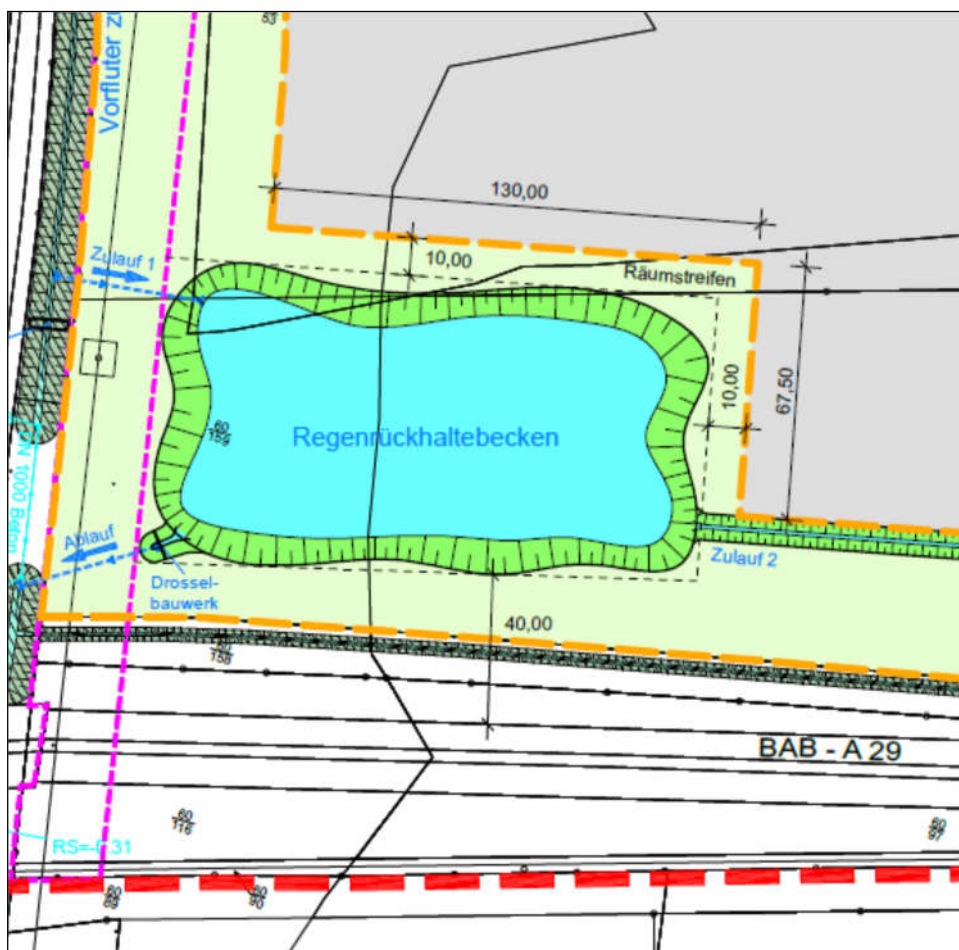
Regenrückhaltebecken (Detail aus Teileinzugsgebietsplan, Oberflächenentwässerungskonzept IST)
